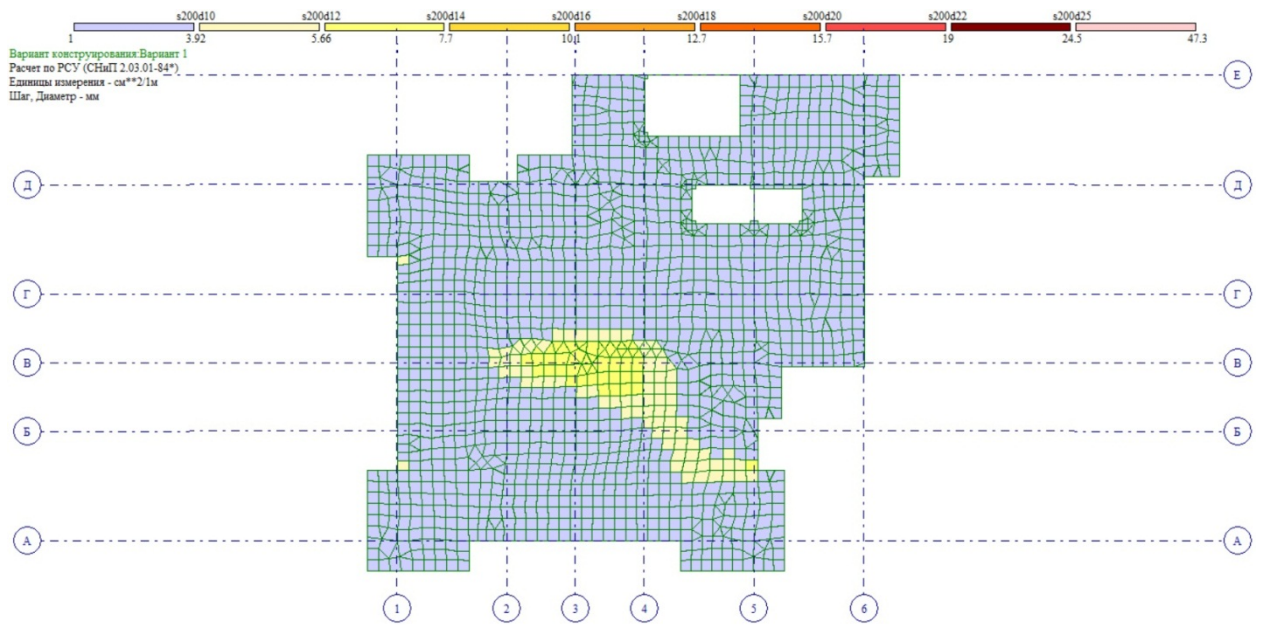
Нижнее армирование плиты вдоль оси У
